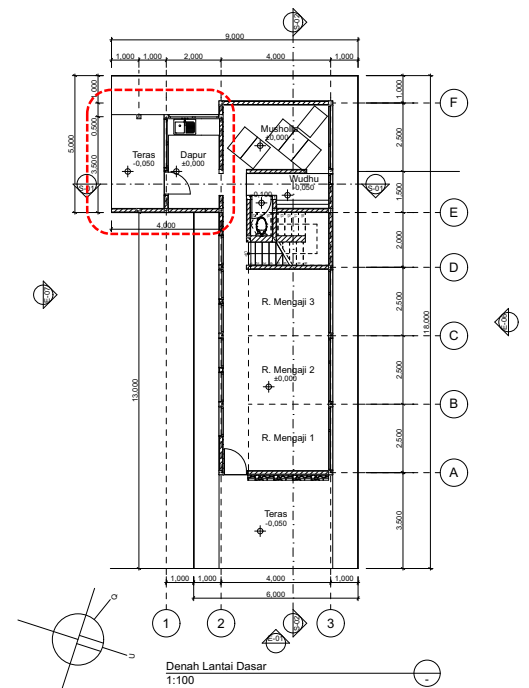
Area penambahan ruang tidur di lantai dasar dan lantai atas (ditandai)
